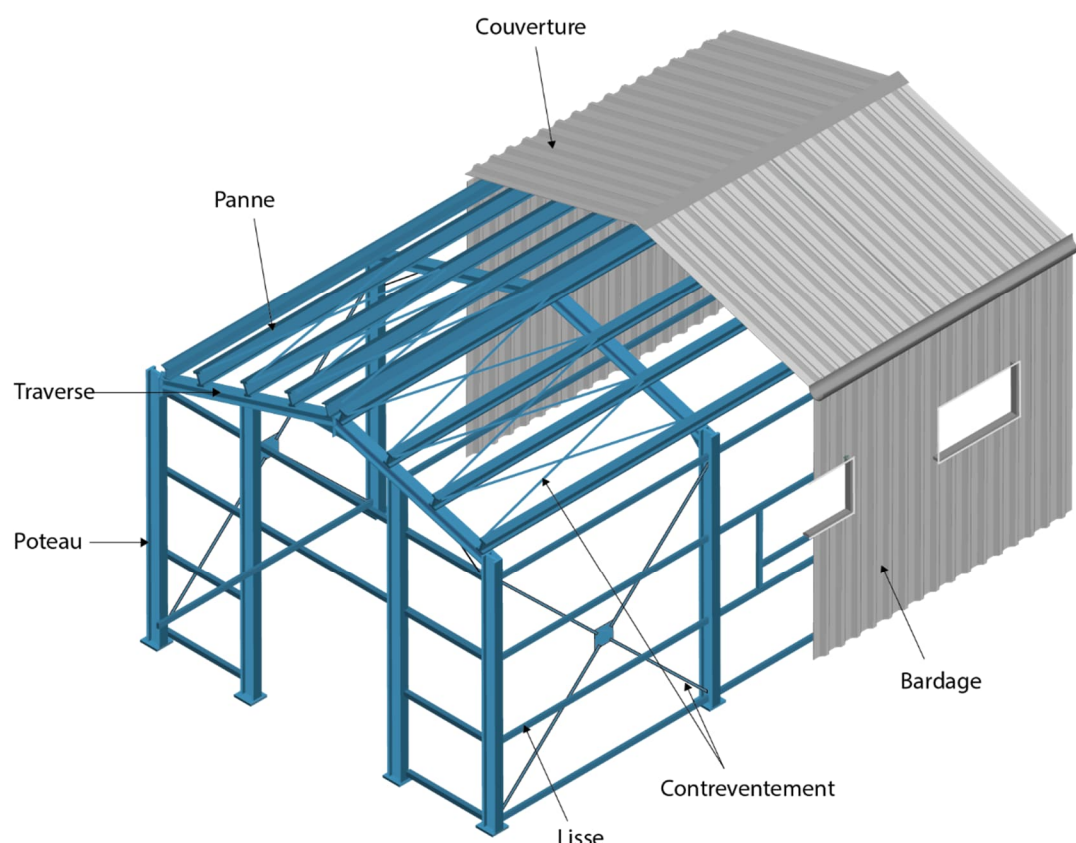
Constituants d'un bâtiment typique à simple rez-de-chaussée avec des portiques plans
